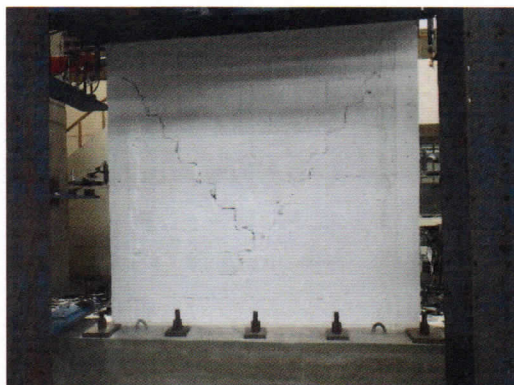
Formación de grietas diagonales en el mortero hasta la parte central del muro para una distorsión 1/1100 Vista cara Sur.
